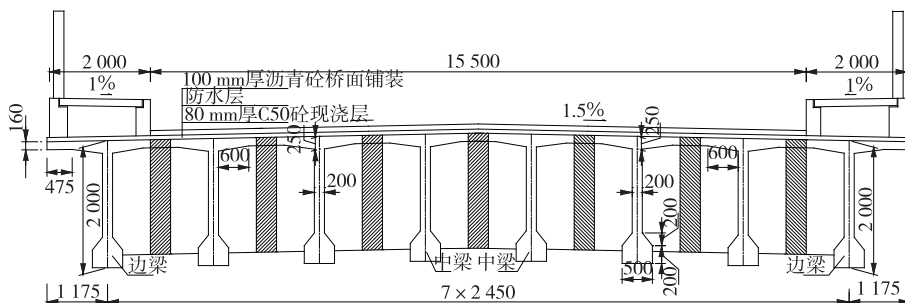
30 m 预应力砼 T 梁跨中断面示意图(单位: cm)
